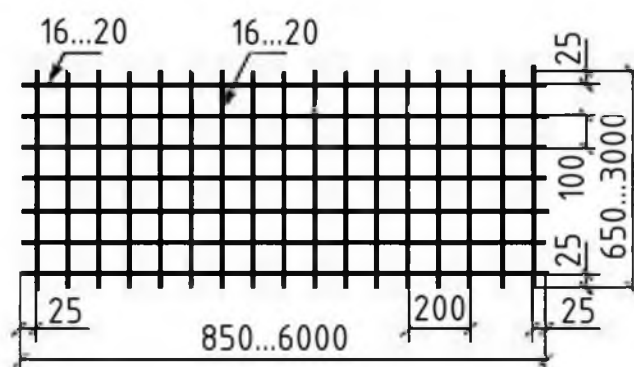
Пример арматурной сварной сетки для железобетонных изделий по ГОСТ 23279-2012
